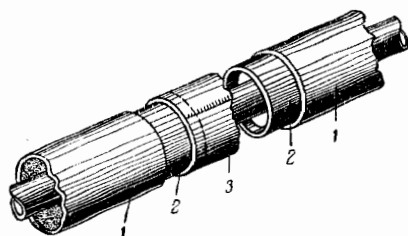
Стыковка оболочек стальными полумуфтами на сварке.
